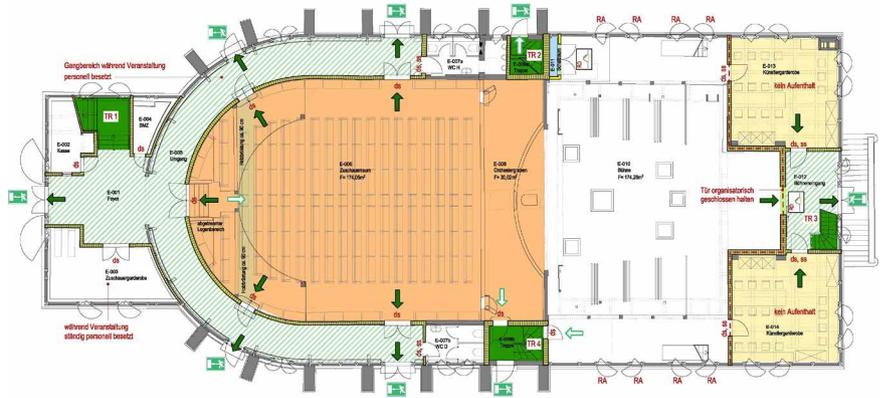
Grundriss Erdgeschoss [13]
